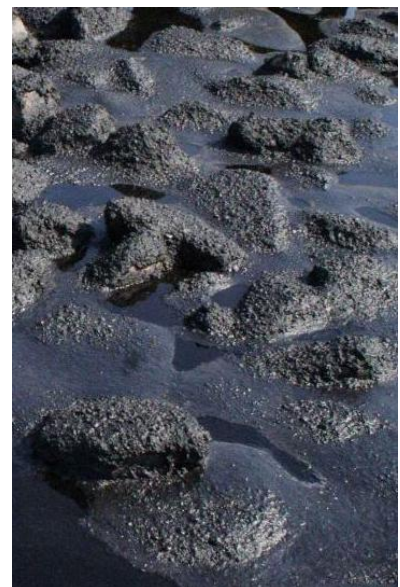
Voorbeeld van vol en zat gepenetreerde breuksteen te Westkapelle (Het Waterschapshuis)
